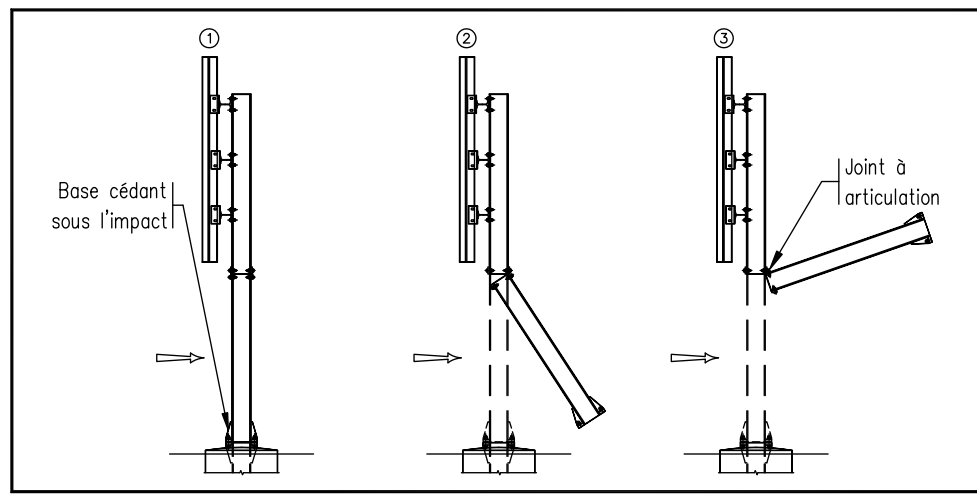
Fonctionnement d'une base à plan de glissement
